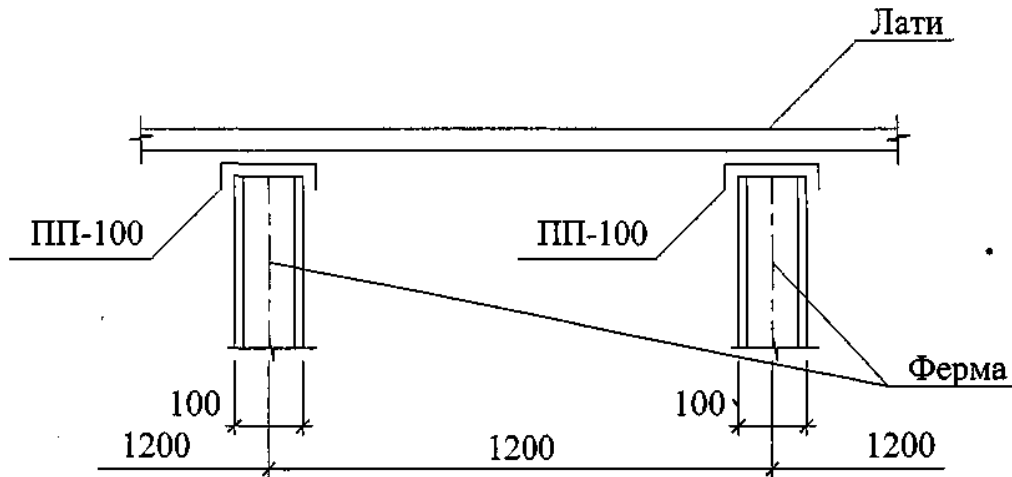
До розрахунку перерізу верхнього поясу ферми
